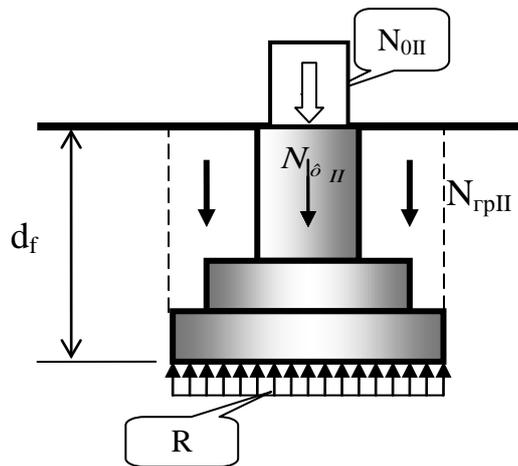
Схема к определению давления по подошве центрально нагруженного фундамента
